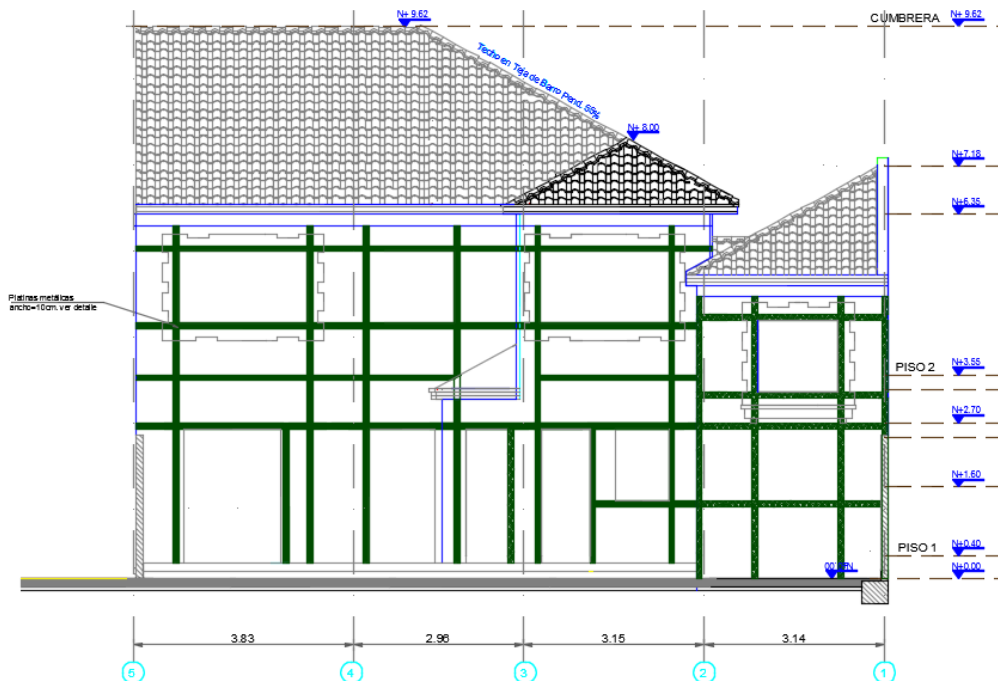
Distribución de las láminas de acero en la fachada posterior de la casa ubicada en la carrera 18 # 34-15. Fuente: Planos de reforzamiento elaborados por el Ing. Manuel Antonio Ramirez Vargas
